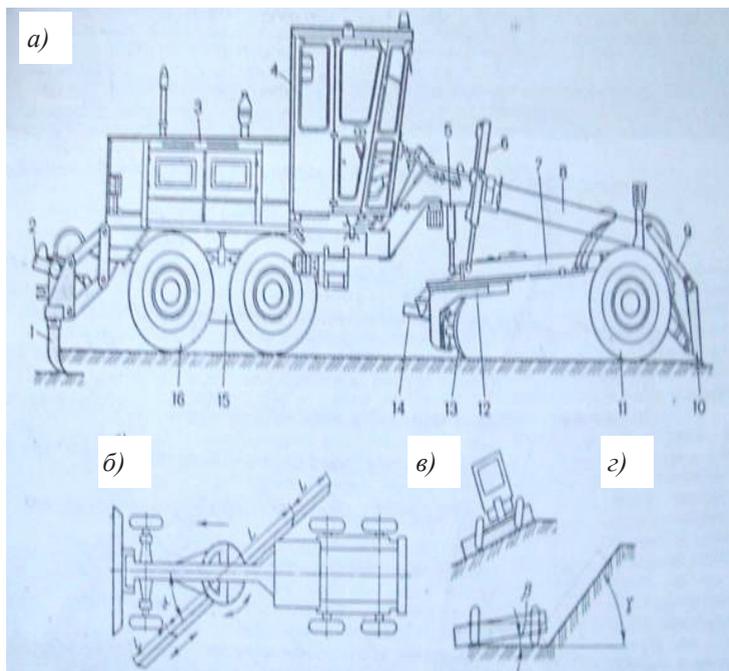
Автогрейдер ДЗ-143: а – общий вид; б – схема поворота отвала в плане; в – схема бокового наклона колес; г – схема бокового выноса отвала
